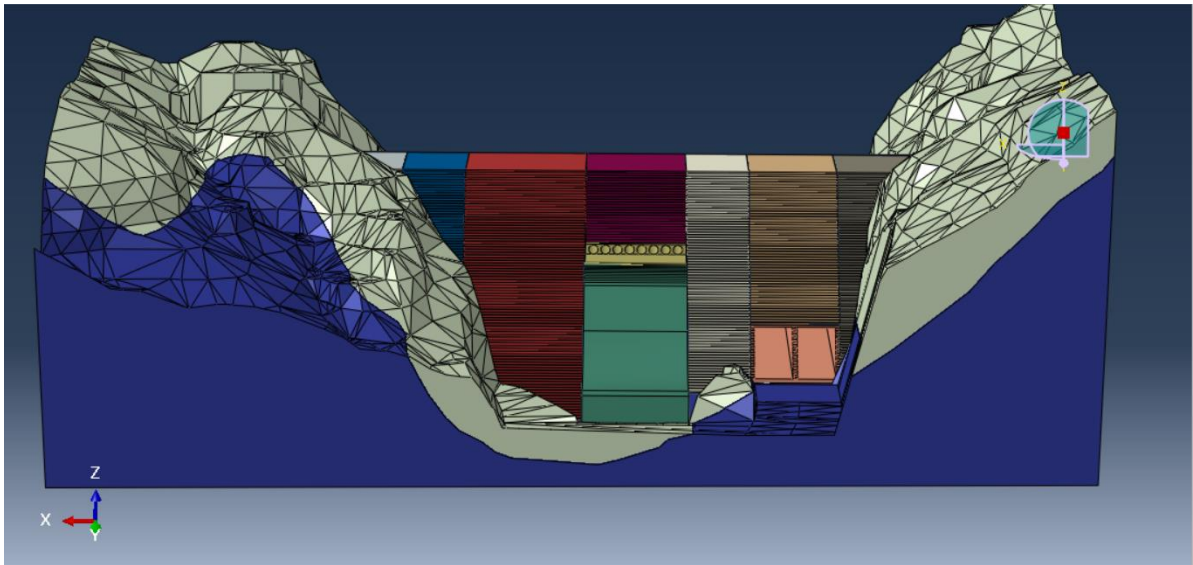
Geometría tridimensional de la cortina de la presa Pilares en la etapa 7 de construcción, en la elevación 210.00 msnm.
